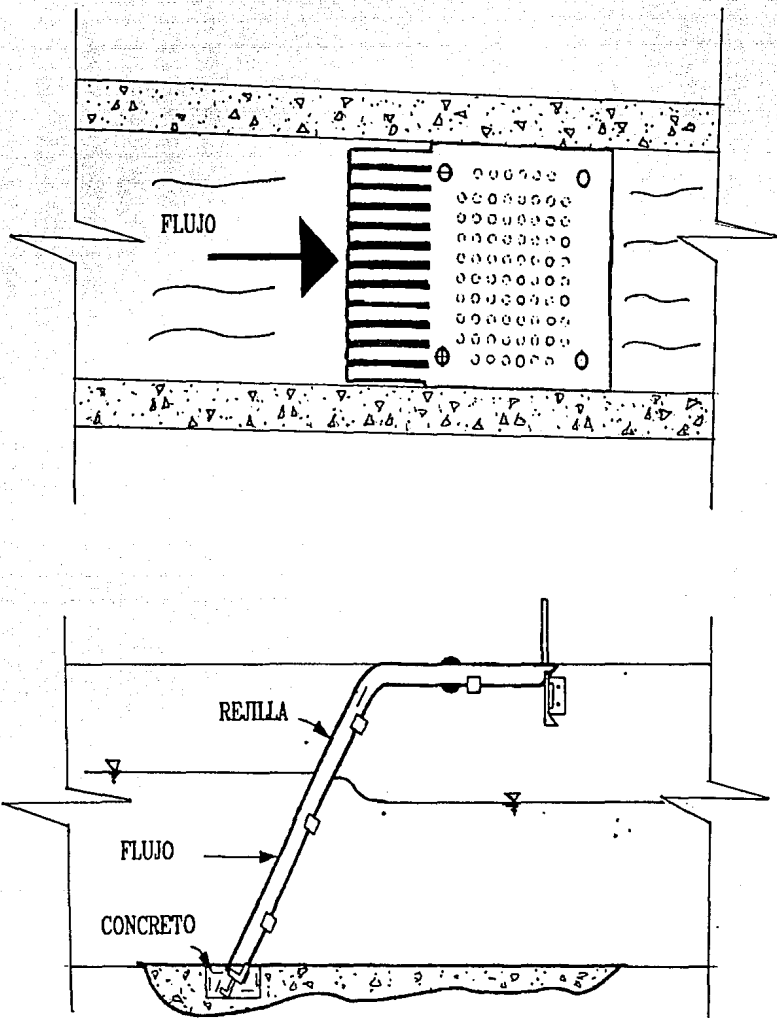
Vista de planta y de perfil de una unidad de rejillas
